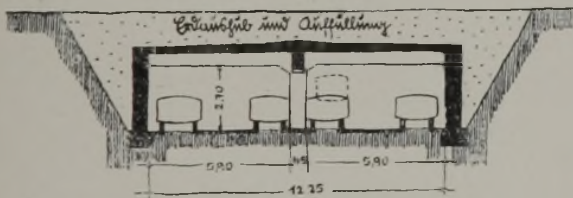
Eisenbetonkeller im gleichen Ausmaß. Aufsattlung bequem möglich bei einer Lichthöhe von nur 2,70 m. Viel geringerer Mauerquerschnitt und weniger Erdaushub.
